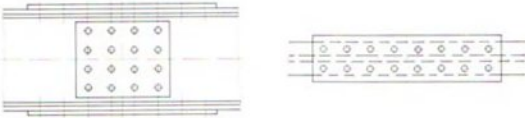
Biegeester Stoß. Für die Biegebeanspruchung werden die Steg- und die Flanschteile mit sog. Laschen entweder mittels Schrauben, Nieten oder durch Schweißung verbunden.
